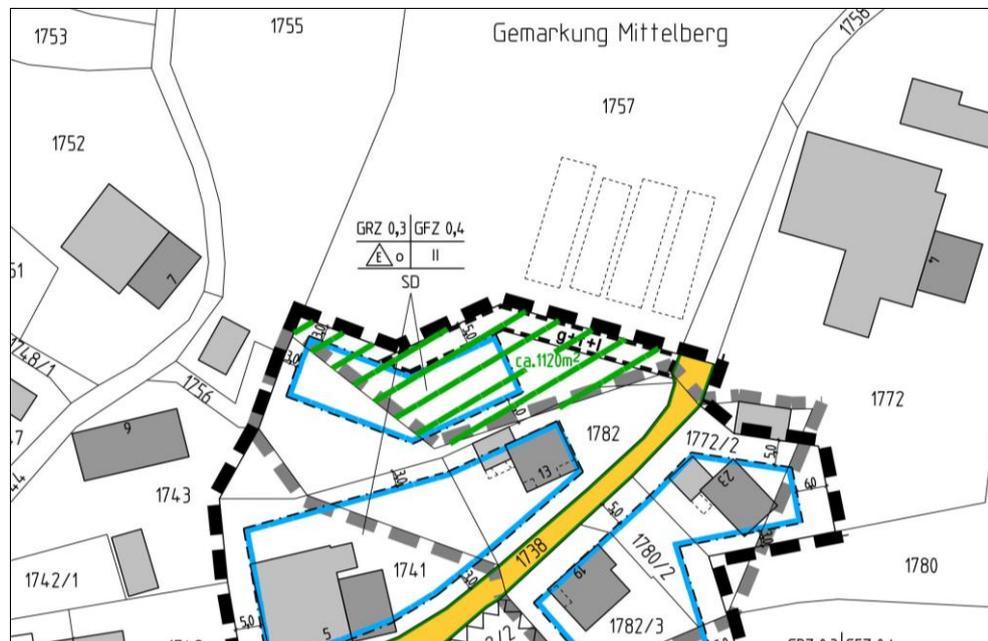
Umgriff wohnbaulich zu entwickelnder Fläche auf Baufeld 1 (grün schraffiert)
